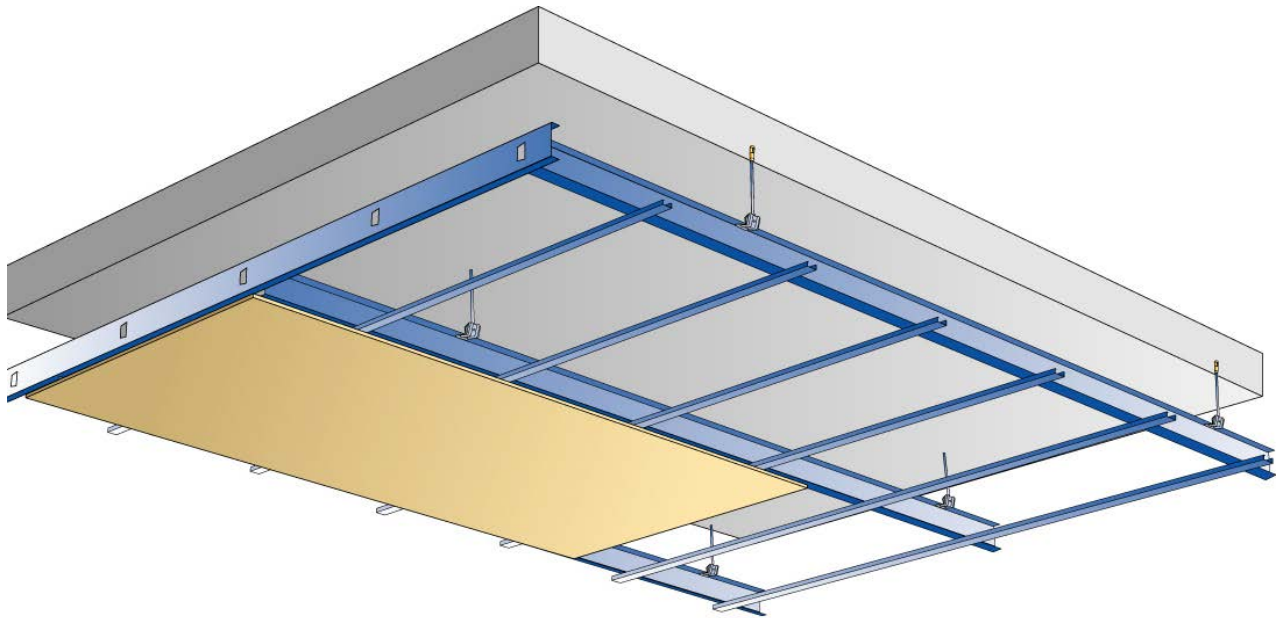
Plafond GYPTONE avec ossature Stil Prim®
